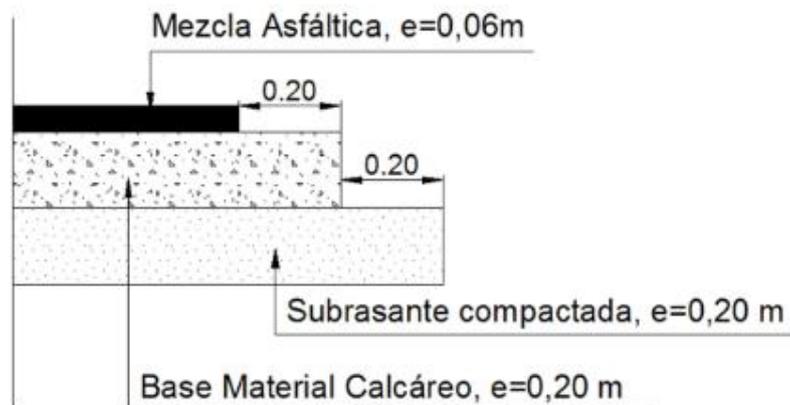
Anteproyecto vial: paquete estructural de la Av. Esilda Tavella, sector sur.
